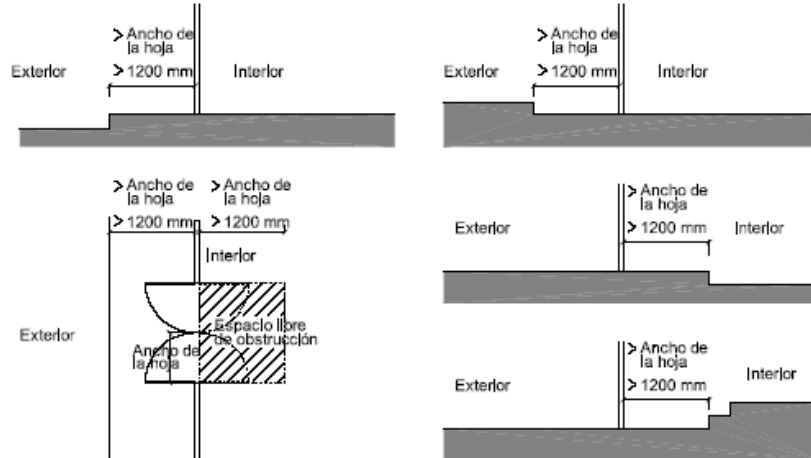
Distancia entre la puerta de acceso y el escalón más próximo
